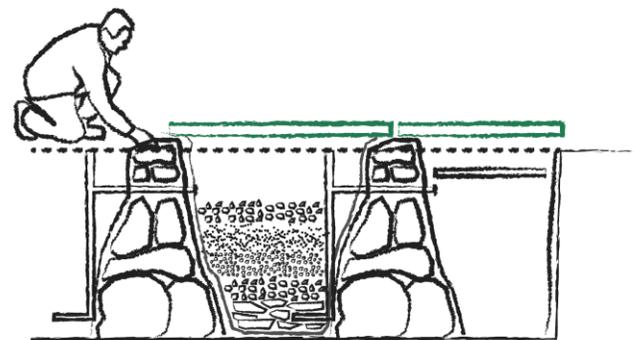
Colocación de tapas de cámaras. Fuente: elaboración propia.
